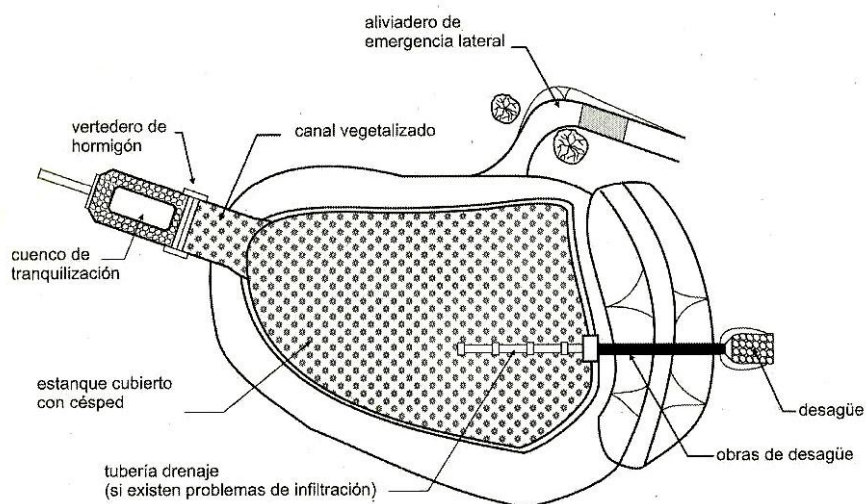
Planta de un estanque de infiltración. Fuente: CEDEX (2008).
